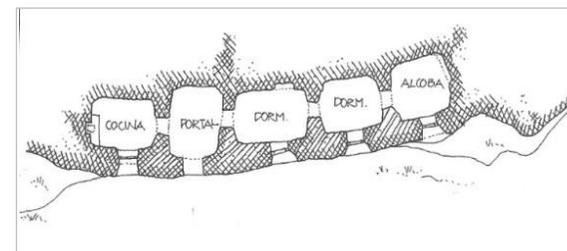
Vivienda excavada en paralelo (Jové, 2006)
